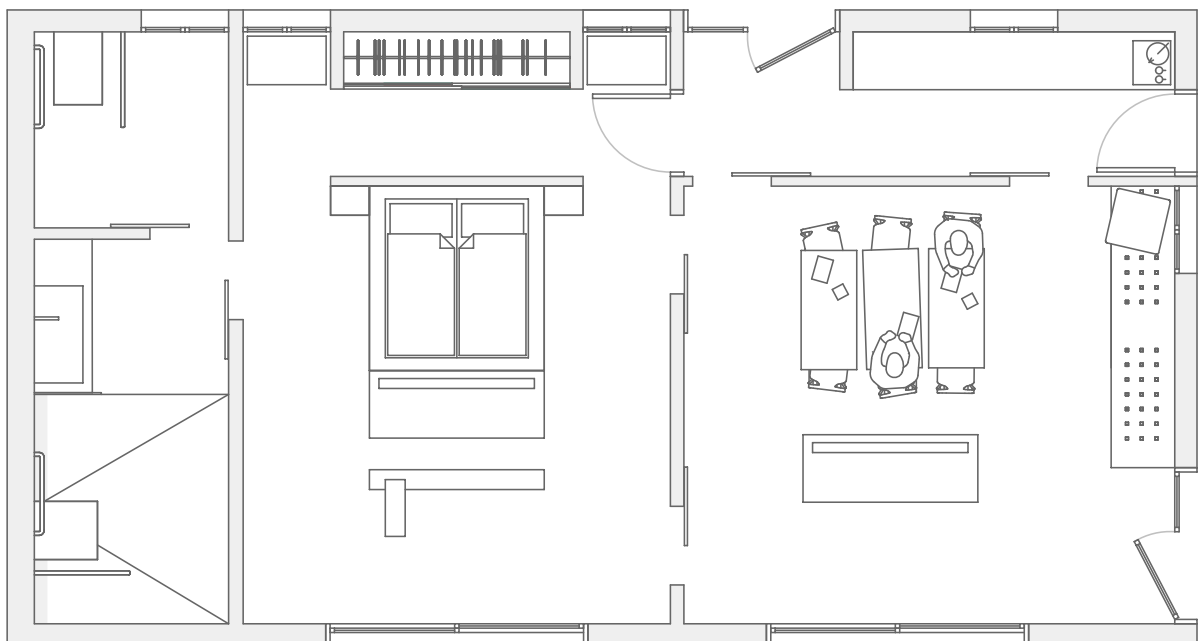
Planta de la villa turística propuesta para este proyecto.
